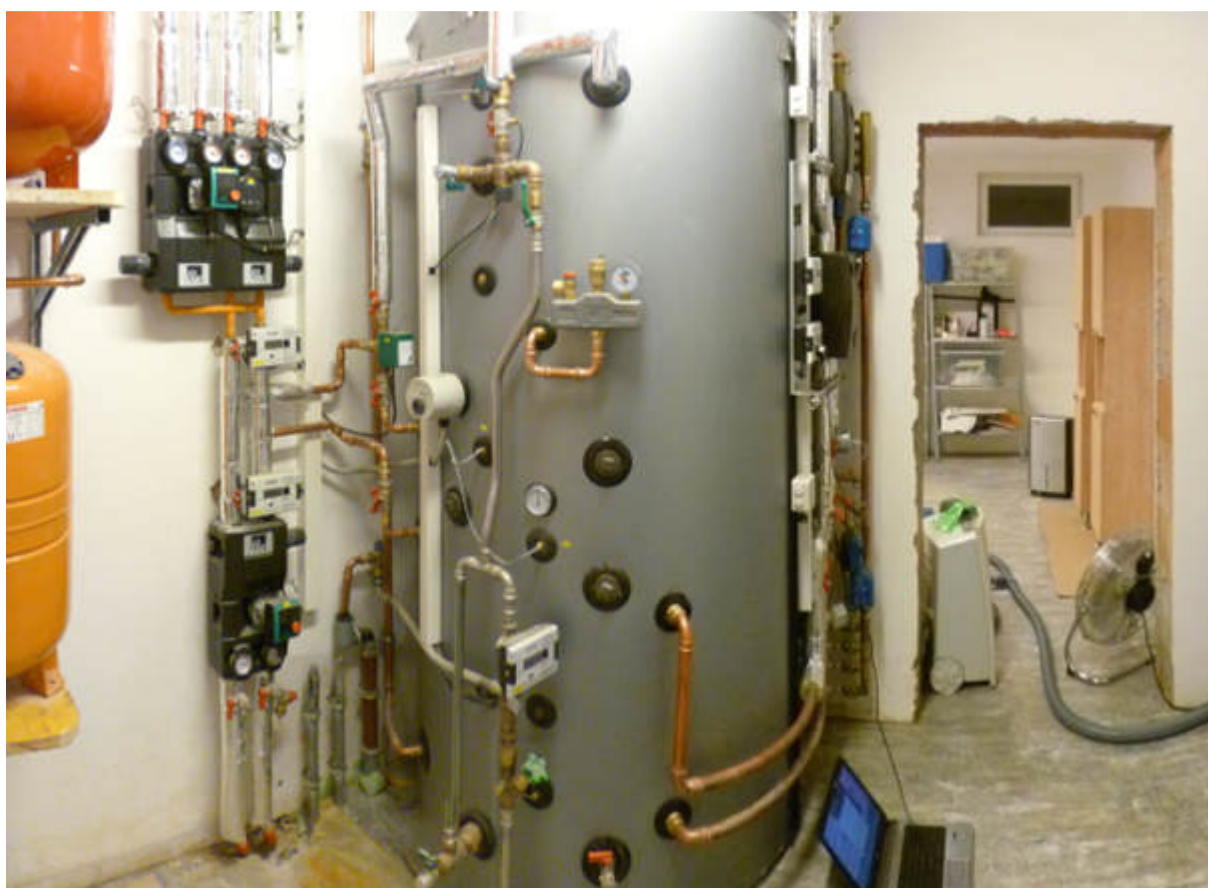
Technikraum mit Pufferspeicher, Pumpengruppe für die Fußbodenheizung (oben) und Pelletskessel (unten), sowie Ausdehnungsgefäße (Quelle: AEE INTEC)
